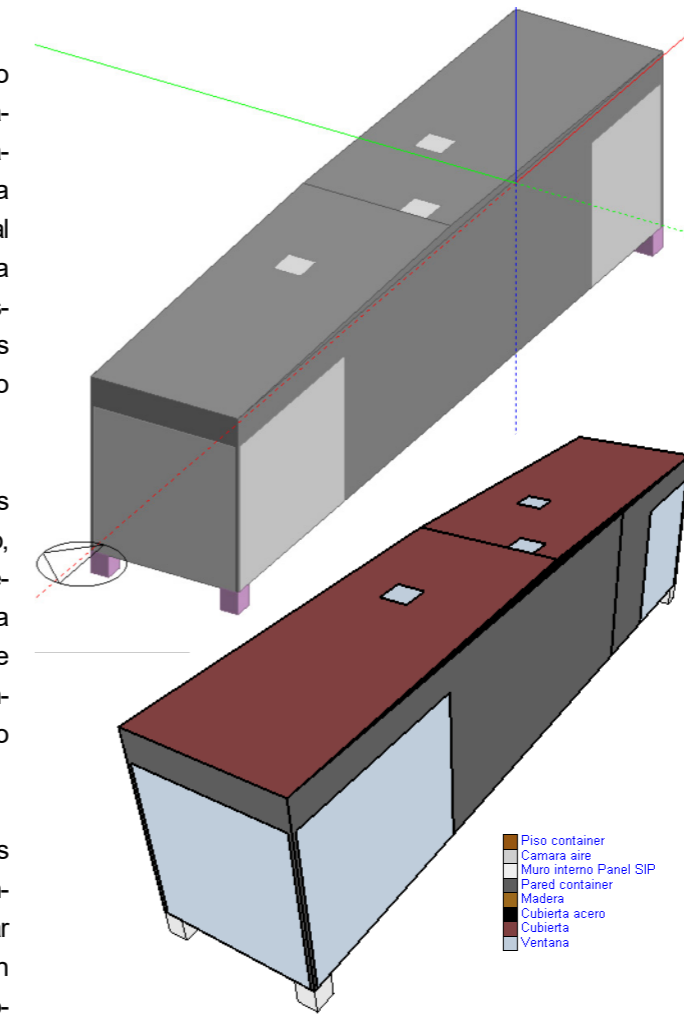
Modelo tridimensional del proyecto en Design Builder
